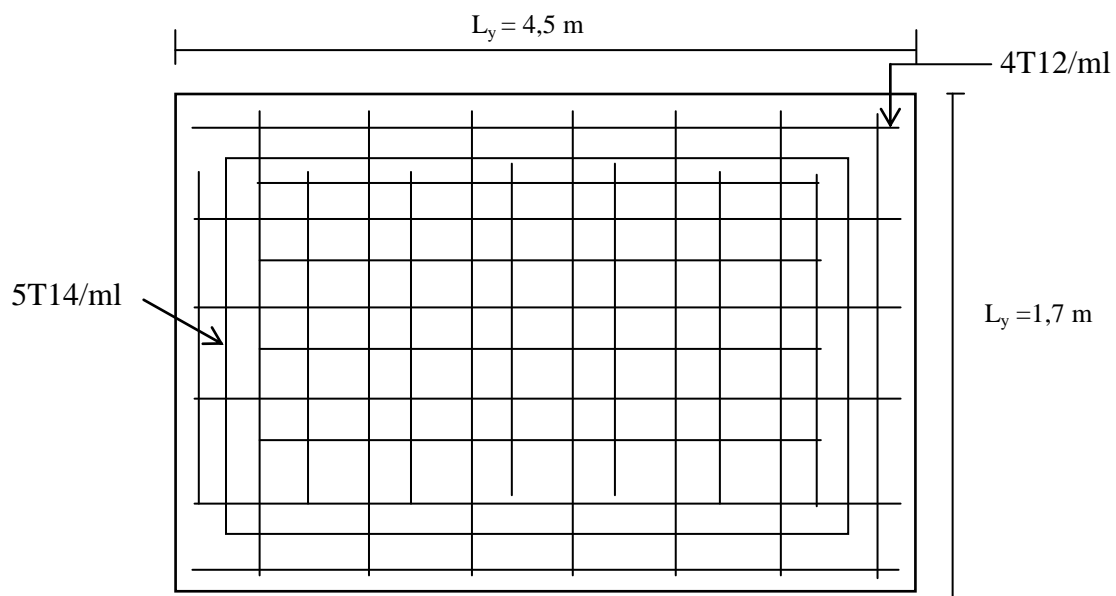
Ferrailage Inferieur du panneau de la dalle pleine.
